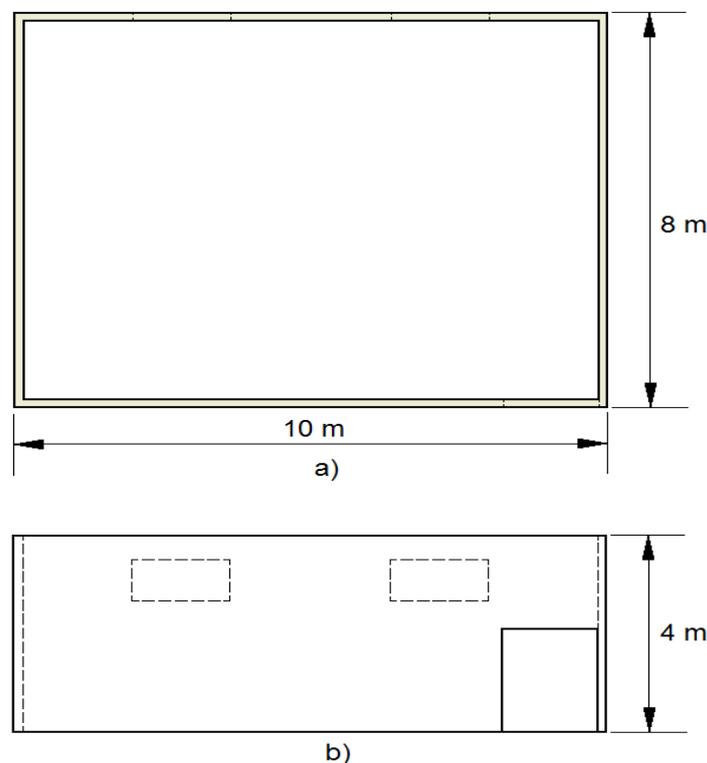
Esquema constructivo del local. a) vista superior b) vista frontal.
